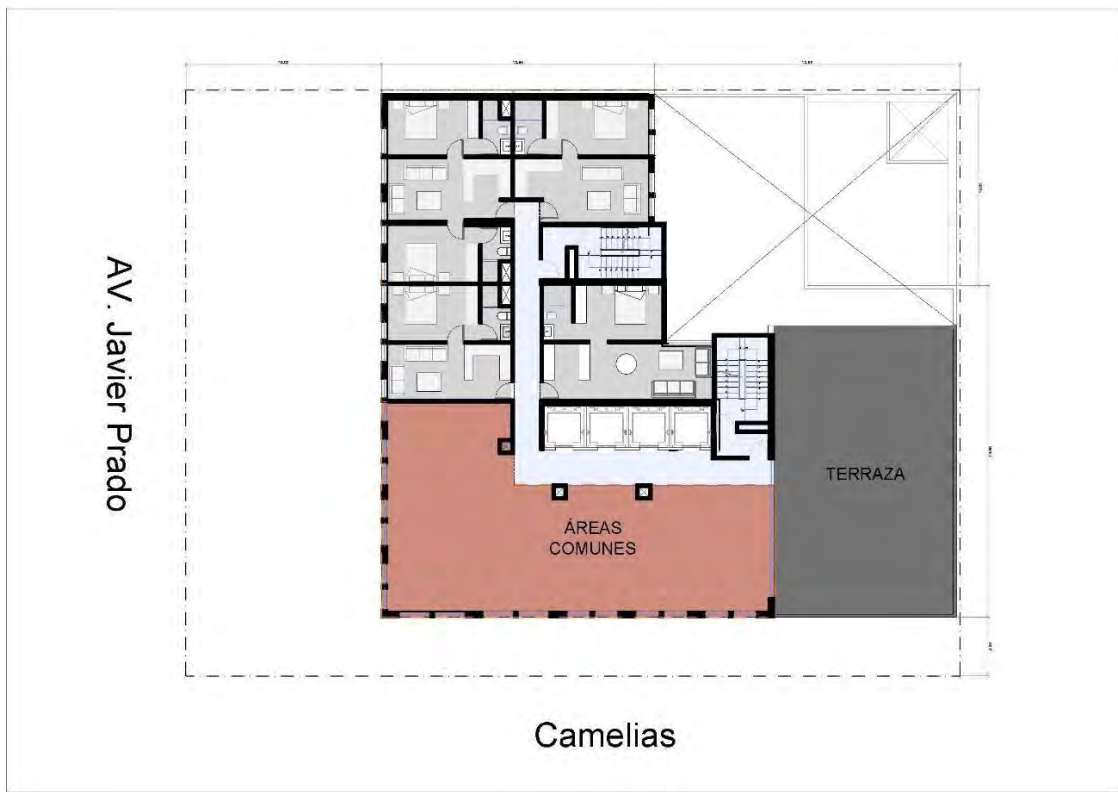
Planta Vivienda, Nivel 13-19
